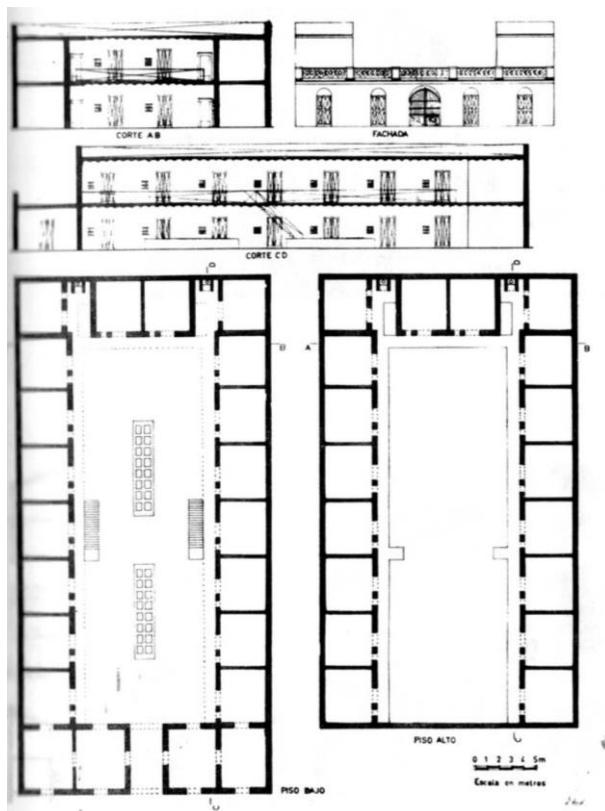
Conventillo Medio Mundo: alzados, planta baja y planta alta.
